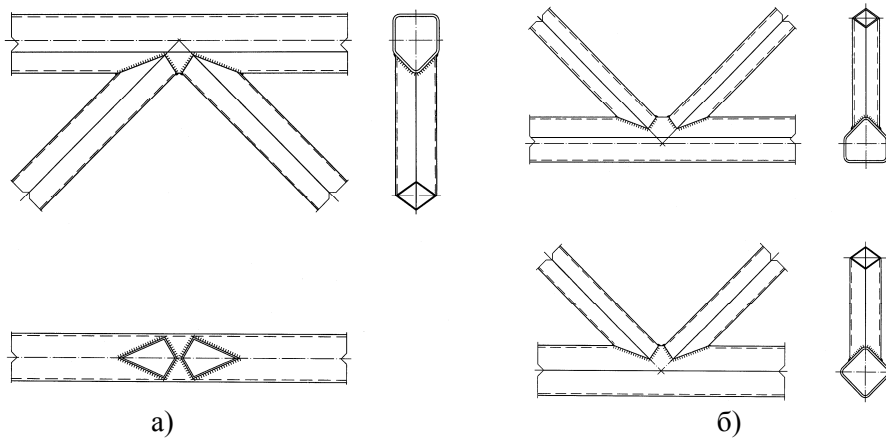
Схемы бесфасоночных узлов решетчатых конструкций из квадратных и пятиугольных труб: а – верхних поясов; б – нижних поясов
